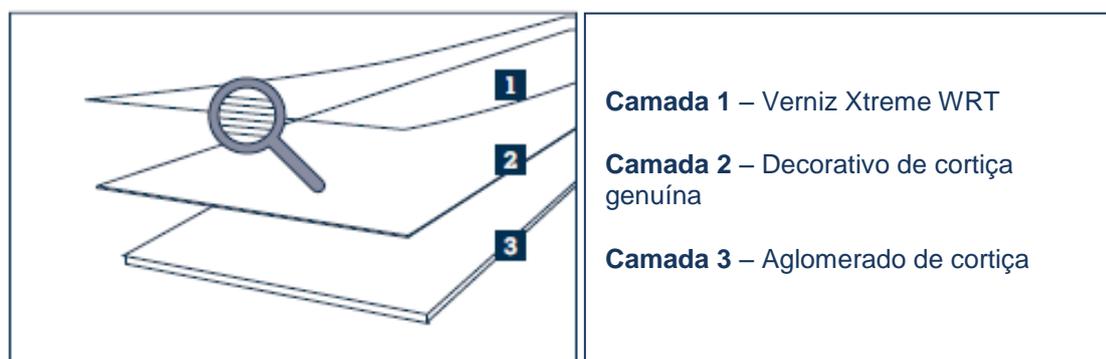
Constituição do Pavimento Colado com Verniz Xtreme WRT [4]
